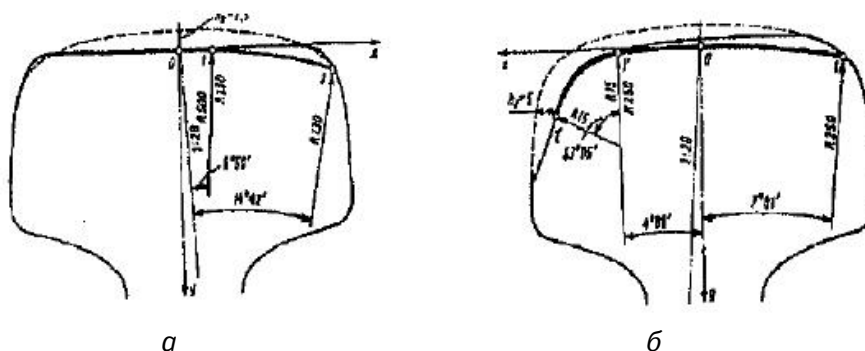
Ремонтный профиль рельсов Р65 для поведения шлифования:
